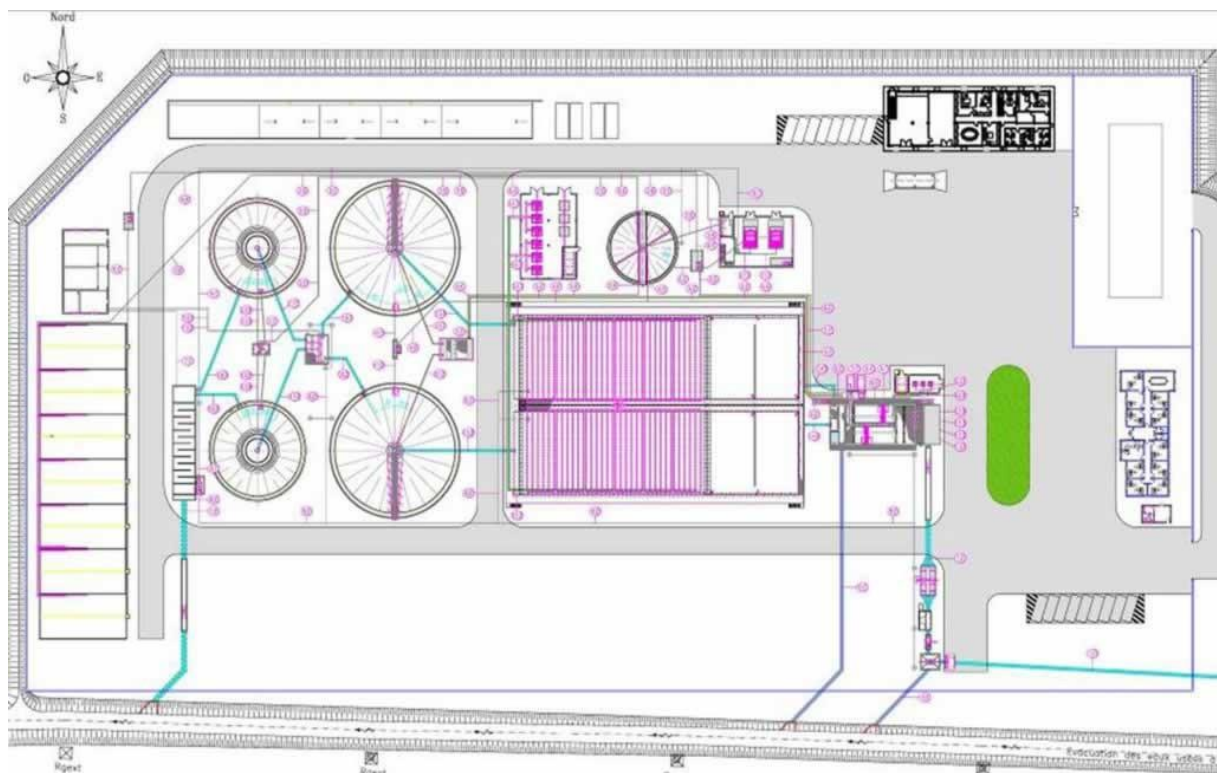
Plan de la station d'épuration des eaux usées d'Ain Témouchent.
